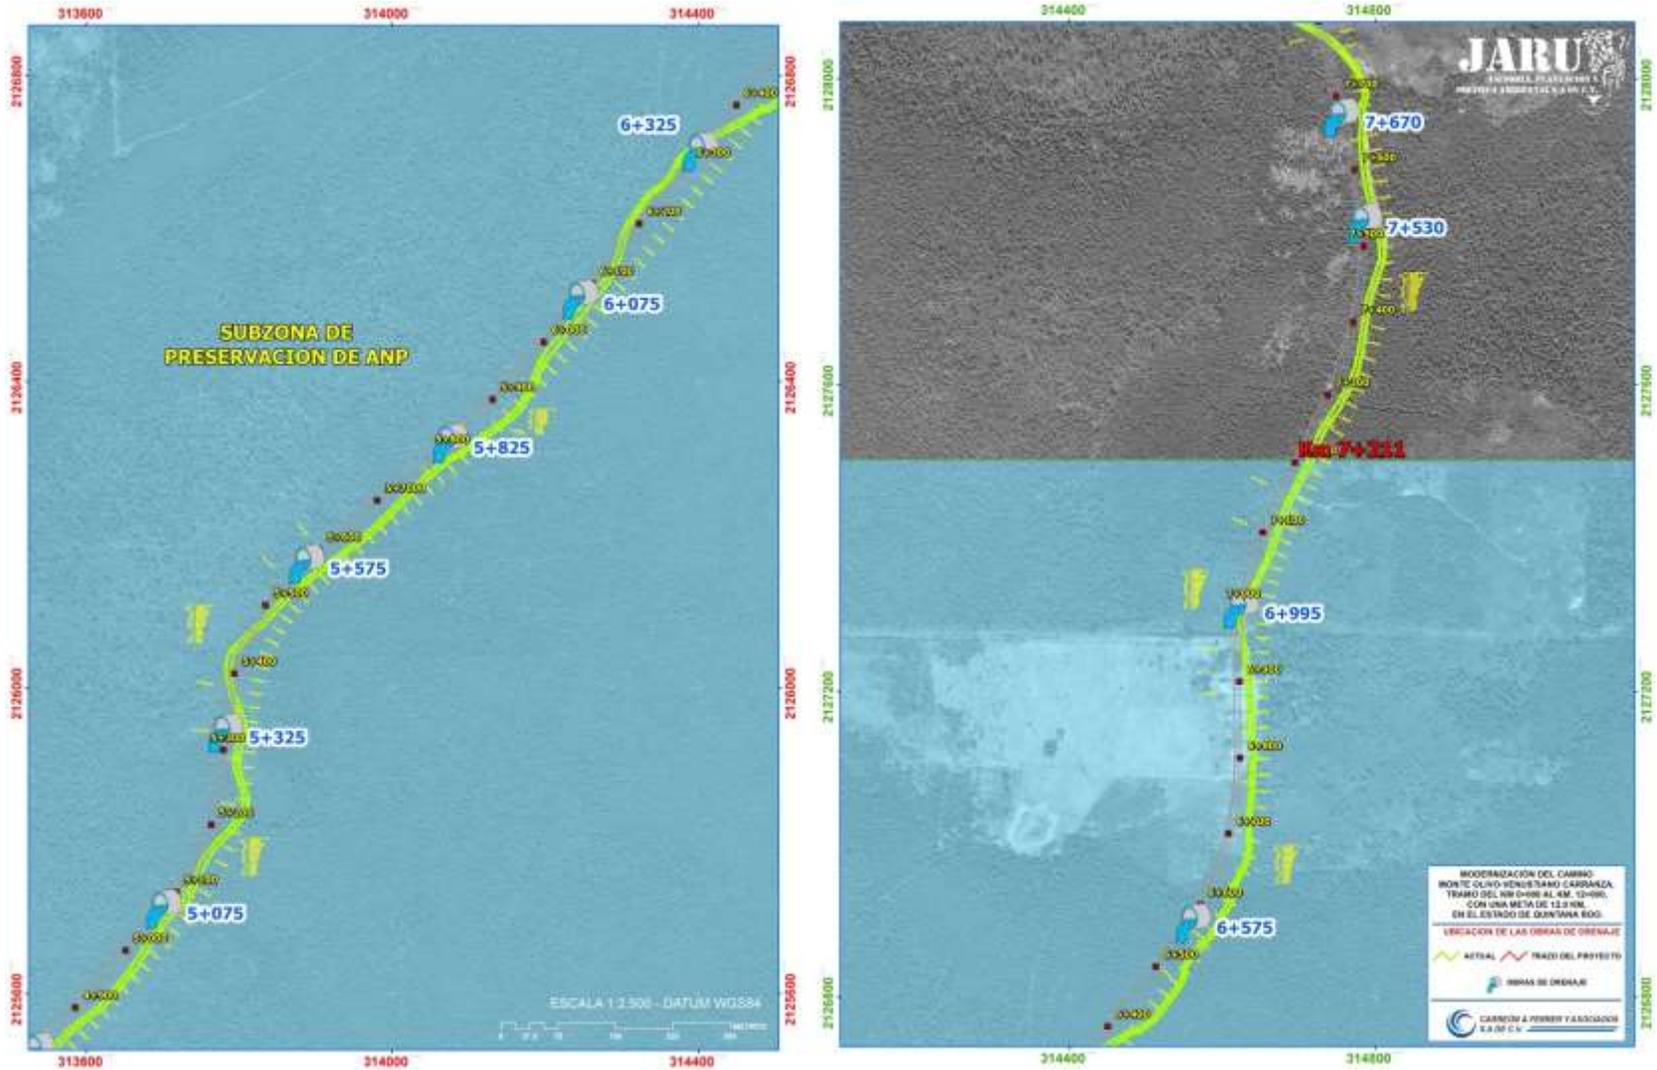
Ubicación de las obras de drenaje presentes entre los Km 4+900 al Km 7+670.
